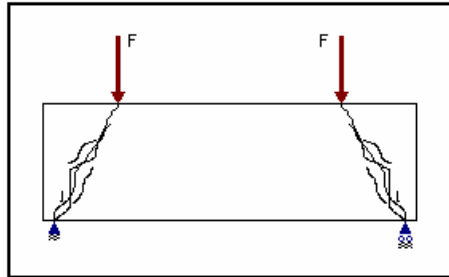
Ruptura tipo viga-parede (O'BRIEN & DIXON, 1994)
